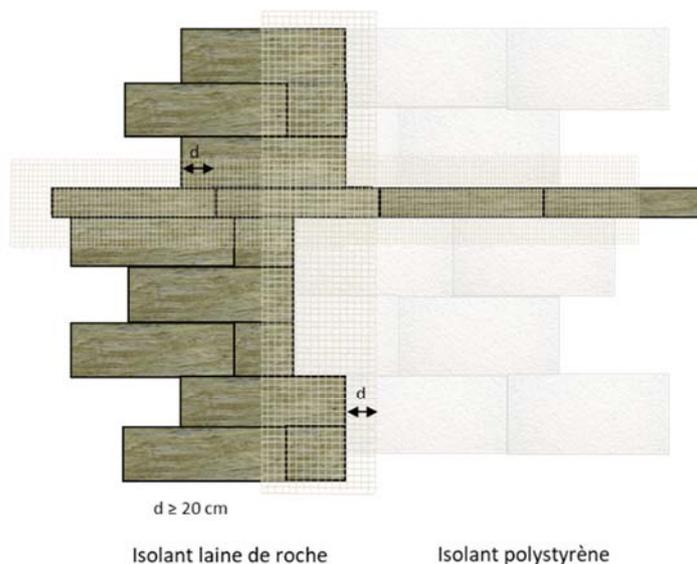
Système StoTherm Brick LDR avec panneaux en laine de roche de dimensions 600 x 1200 mm
